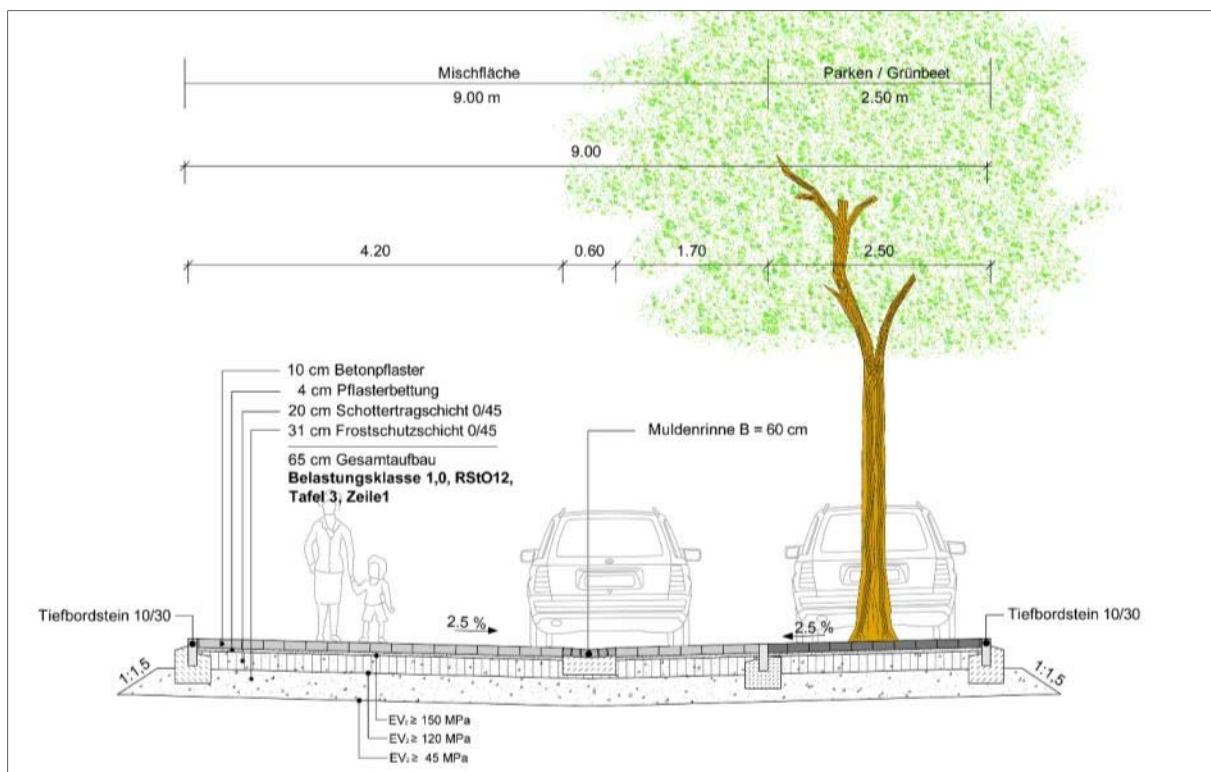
Möglicher Querschnitt Planstraße A (Bereich WA 1)
